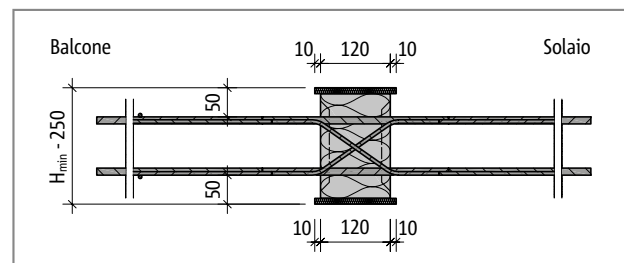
Schöck Isokorb® tipo DXT-CV50, REI120: sezione dell'elemento
